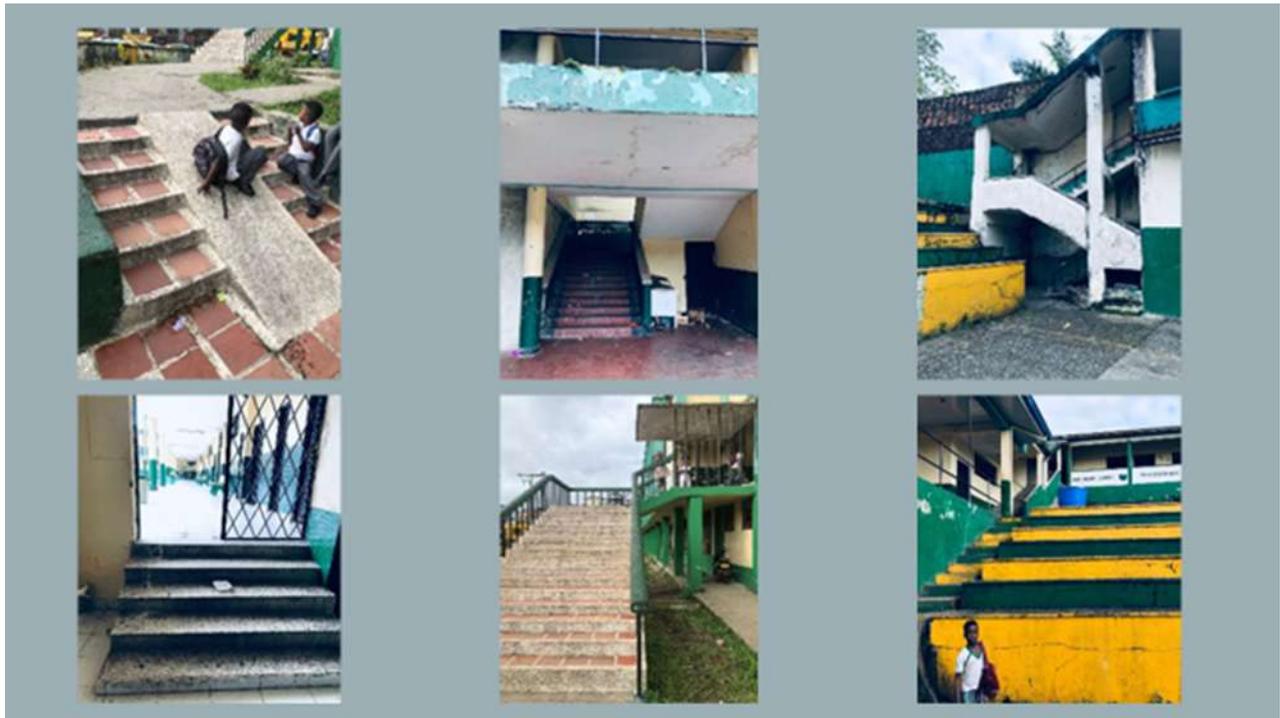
Infraestructura de accesibilidad rampas, escalera [Fotografías]
